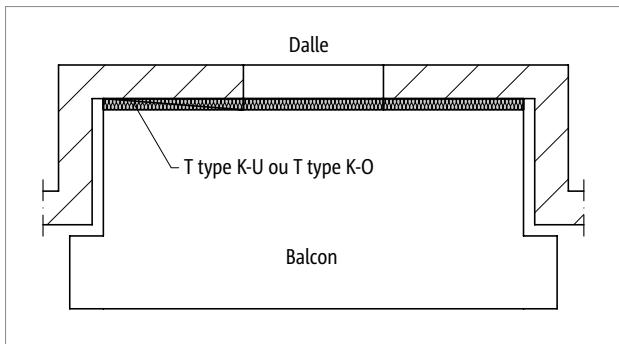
Schöck Isokorb® T types K-U/K-O : balcon dans le cas d'un retrait de façade
